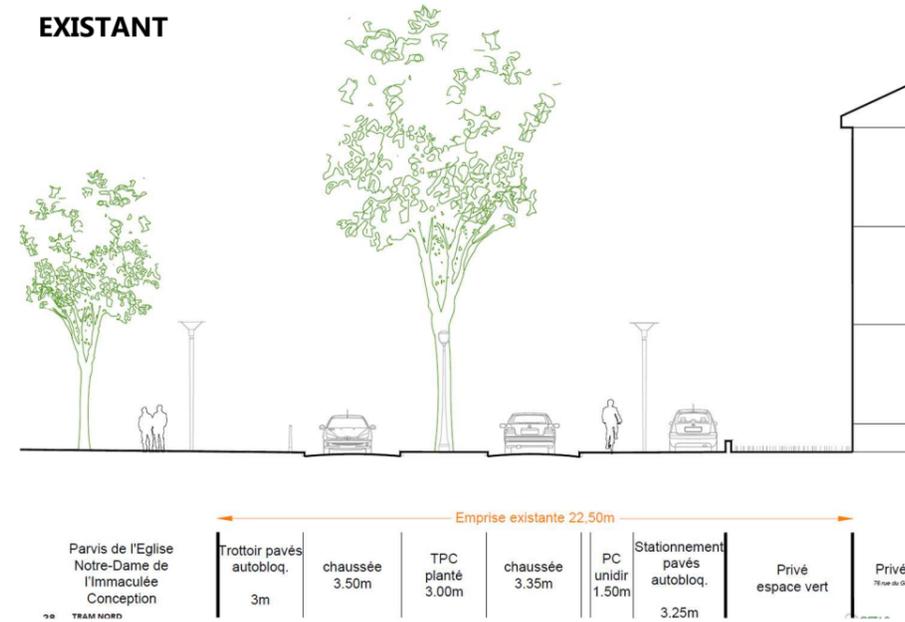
Plan de la route du Général de Gaulle Nord (source : AVP, GETAS 2023)
